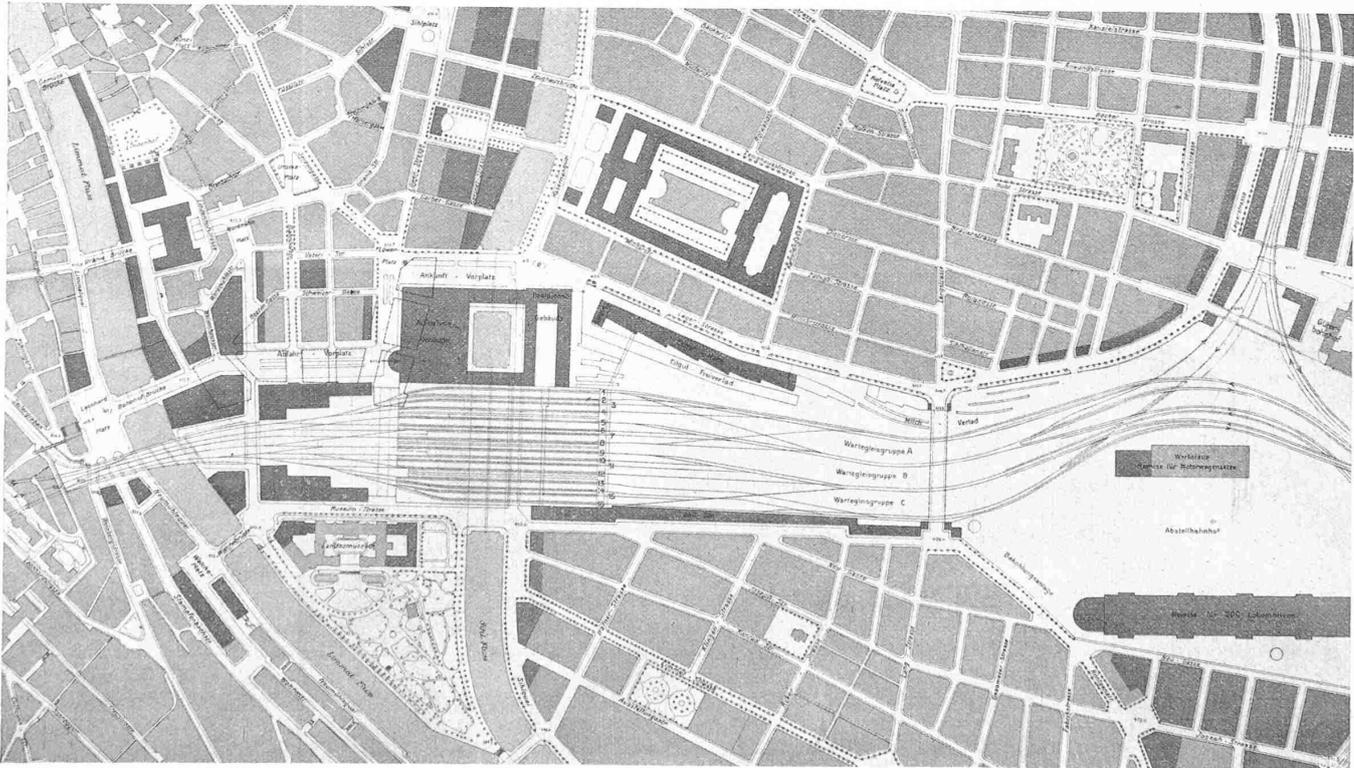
Bebauungsplan zum Durchgangsbahnhof 1918, Arch. Prof. K. Moser. — Ausschnitt im Masstab 1 : 10 000.
